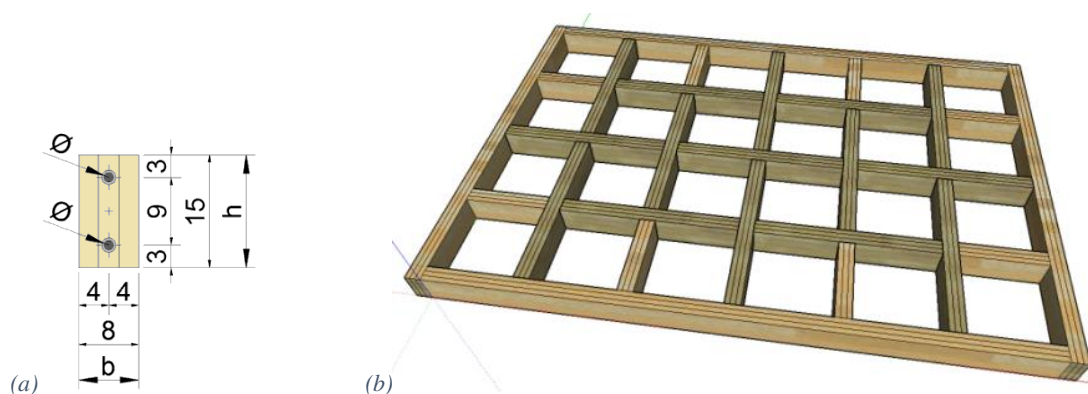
Detalhes do projeto na concepção da estrutura: (a) Seção transversal das peças MLC idealizado para montagem do protótipo experimental da GRELHA MLC-GLULAM ilustrando-se a modulação em (b). Fonte: Brito (2018).
